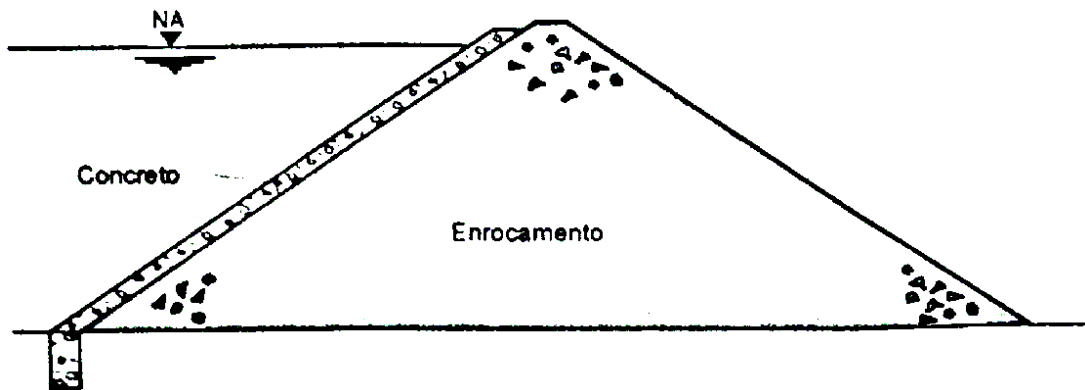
Barragem de enrocamento com face de concreto (Fonte: MASSAD, 2010)
